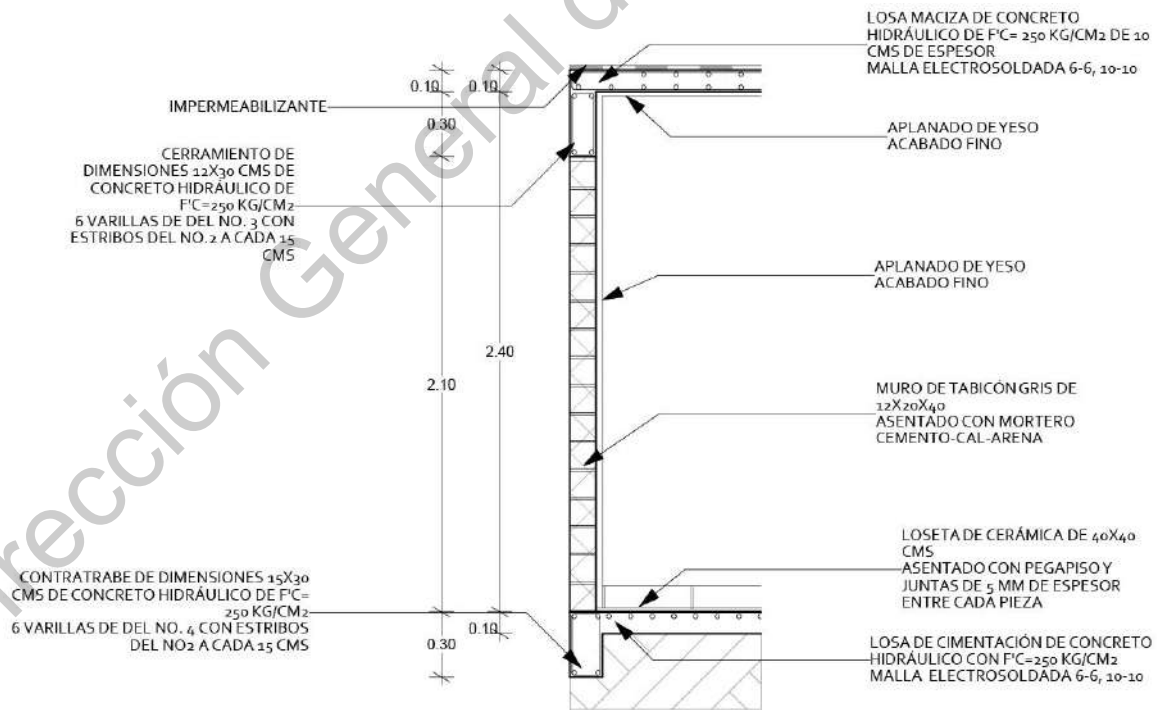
Corte por fachada de muro de colindancia. Elaboración propia.
